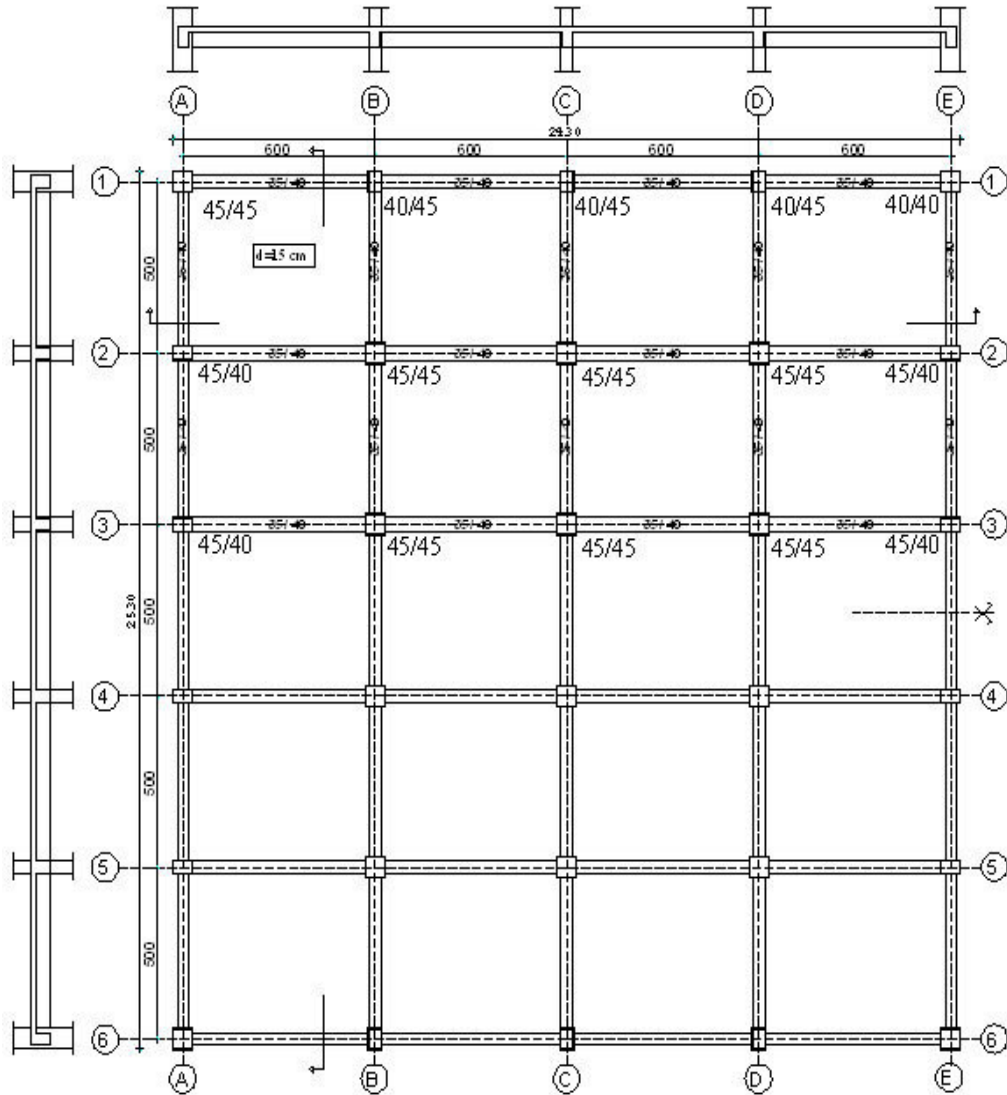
Oluşturulan 6 katlı yapının plan görünüşü
